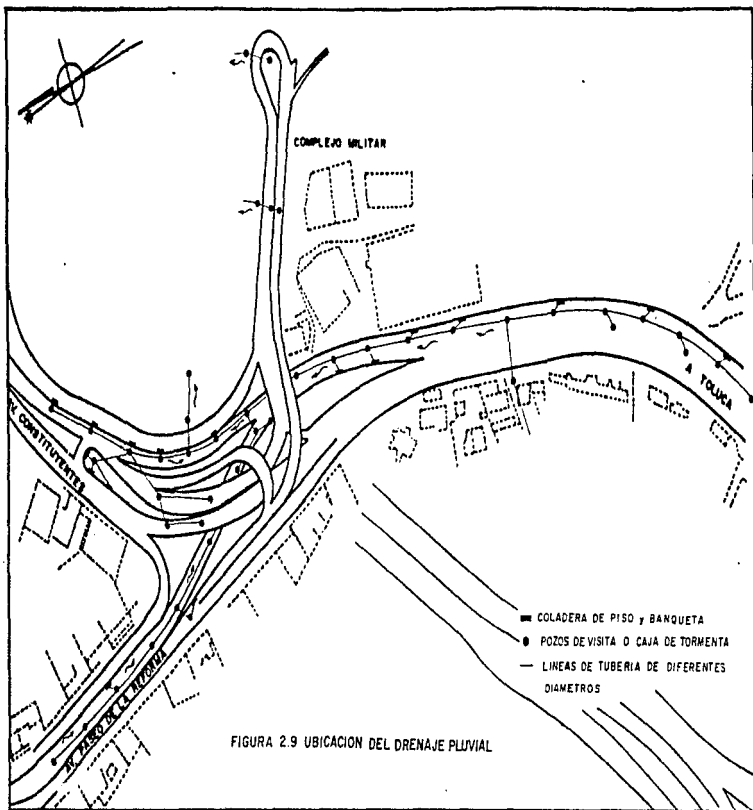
UBICACION DEL DRENAJE PLUVIAL
